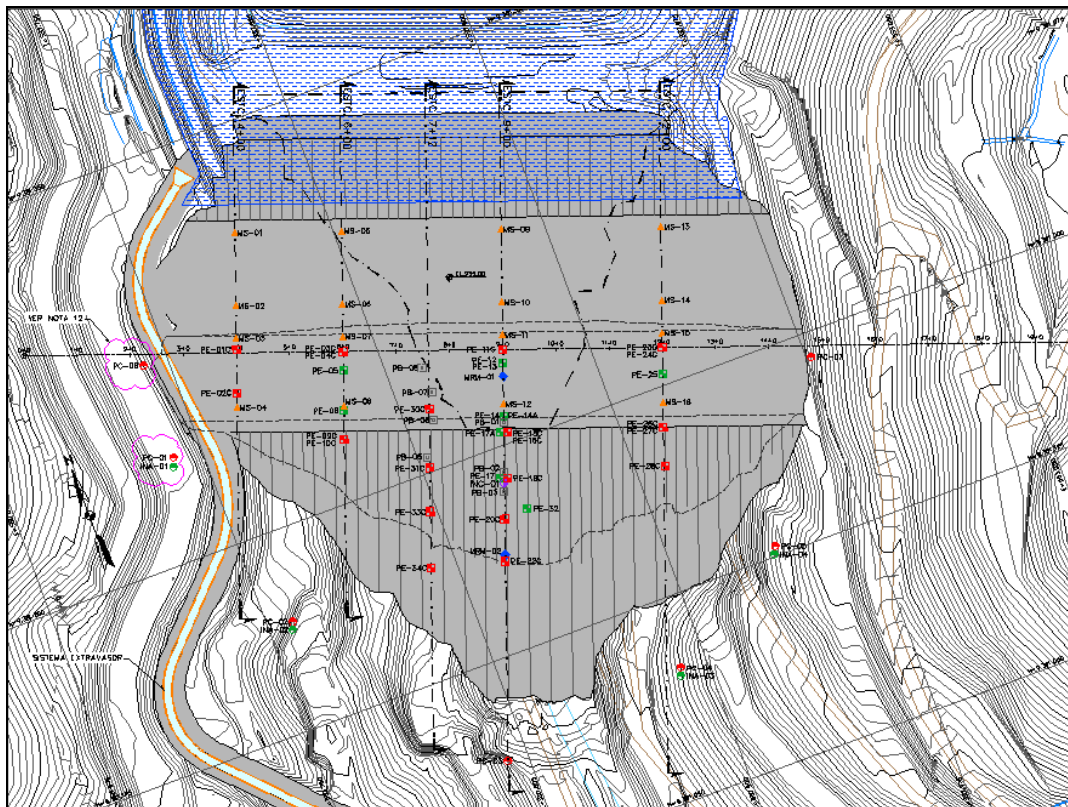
Planta de Locação das Seções de Análise – EL. 235 m
